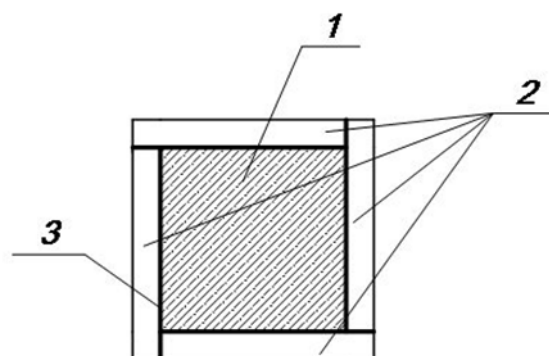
Наружная усиливающая конструкция колонн: 1 – железобетонная колонна, 2 – сборные железобетонные плиты, 3 – обмазка из жидкого стекла
